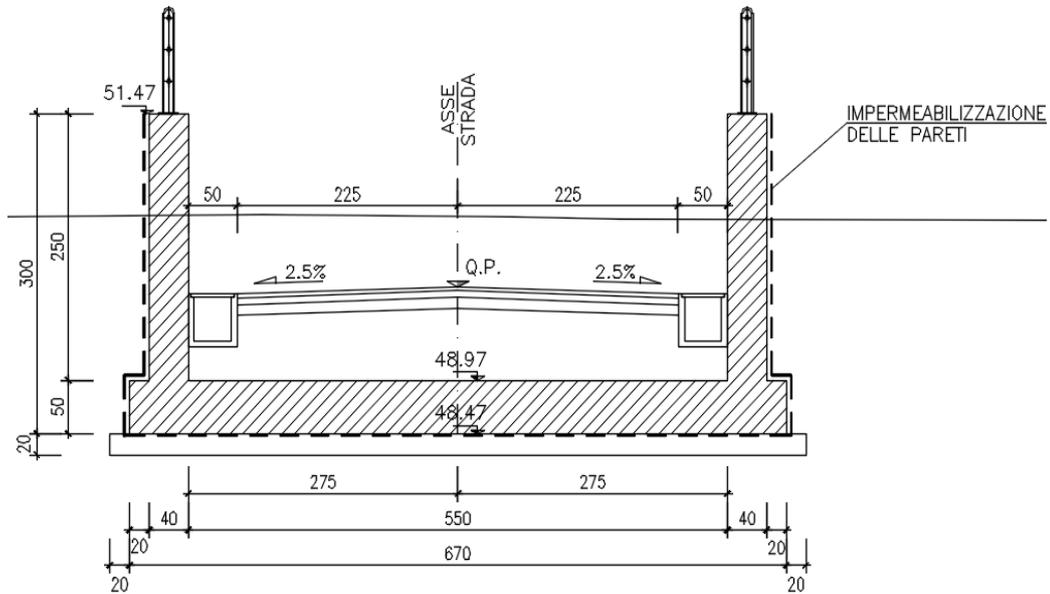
Sezione 3 di calcolo muri di imbocco SL13
